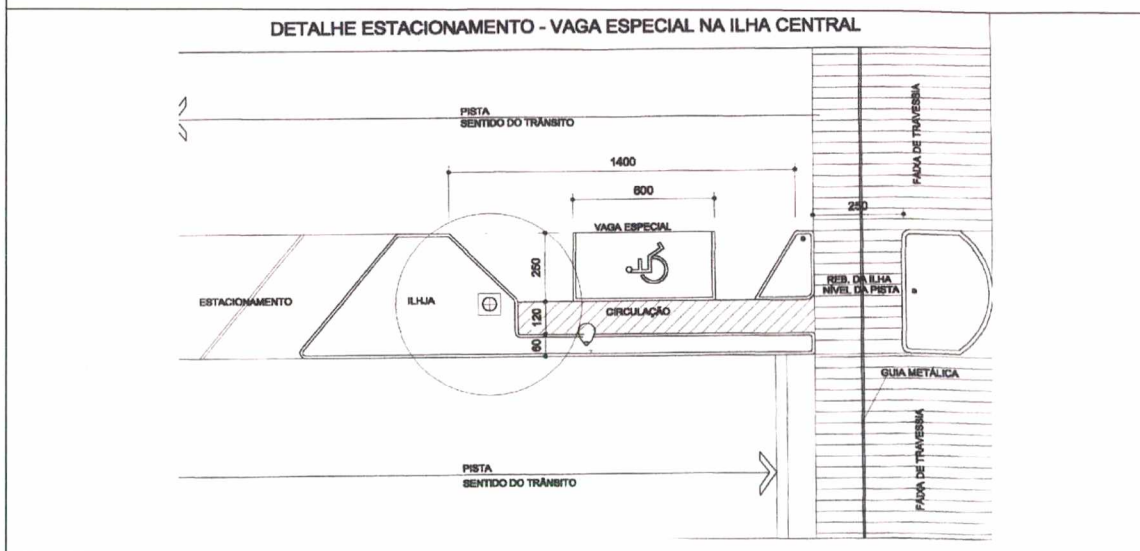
Planta baixa do cruzamento, com localização de rampas, faixas de travessia, rebaixamento da ilha central, e vaga especial.
